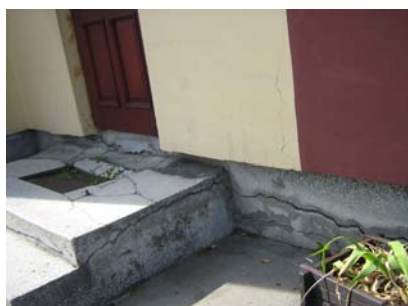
Sala gimnastyczna wschodnia – ZSPiG w Krobi – elewacja wschodnia
